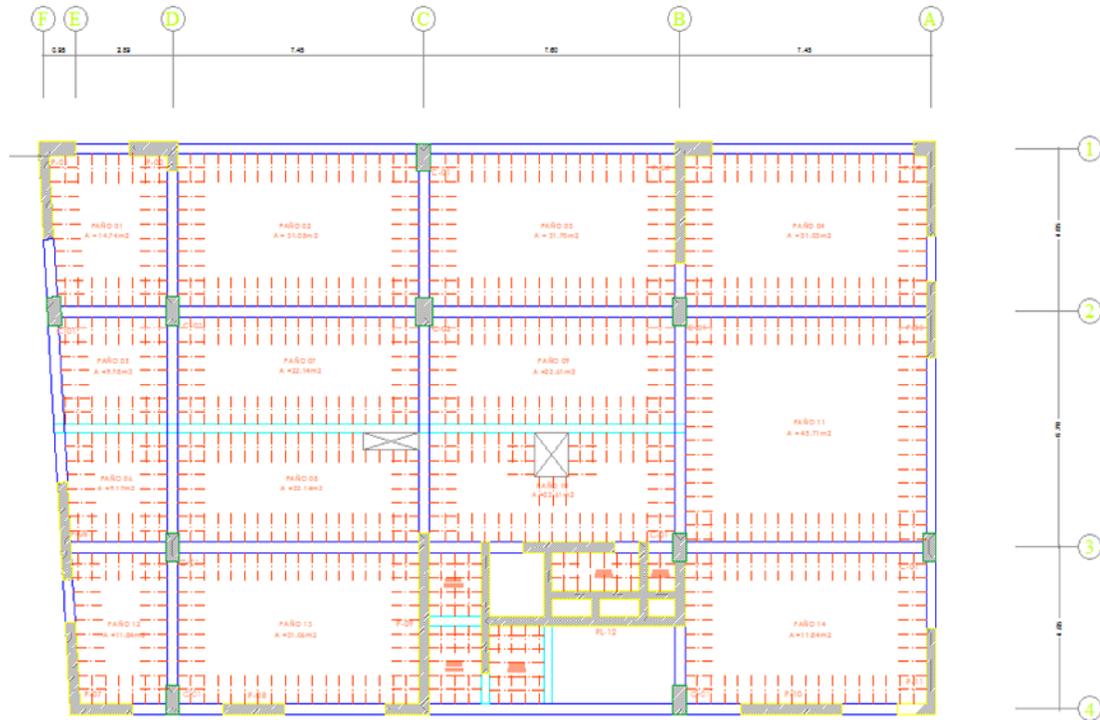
Dirección del Aligerado en Planta – Estacionamiento.
